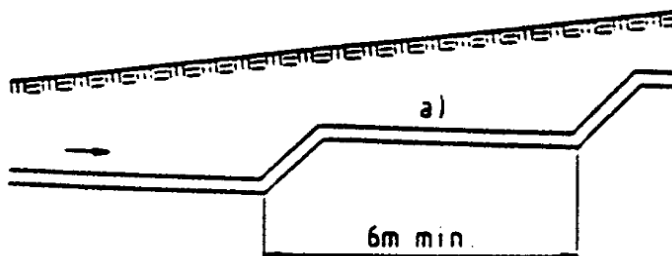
Ejemplo de perfil de redes de alcantarillado por vacío para transporte ascendente.
